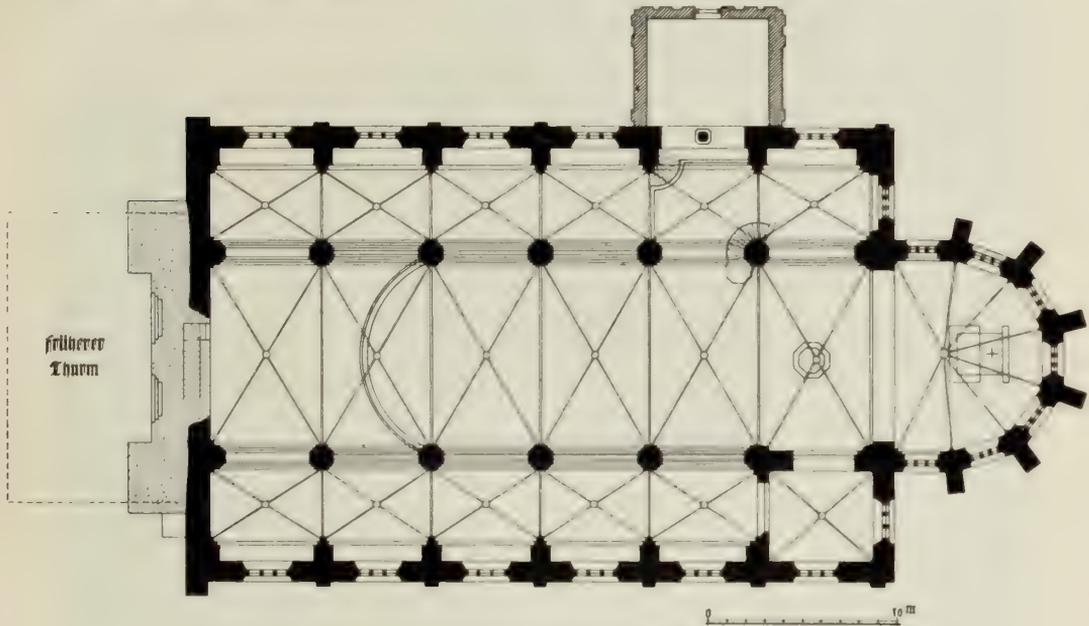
Kyritz. Grundriß der Pfarrkirche.
